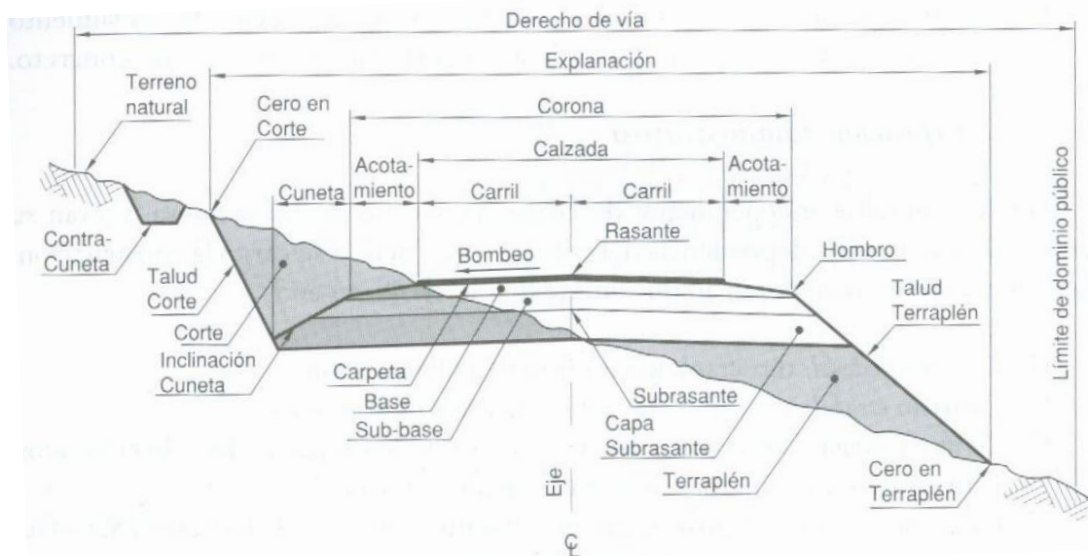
Sección transversal típica mixta, pavimentada en recta (James Cárdenas)
